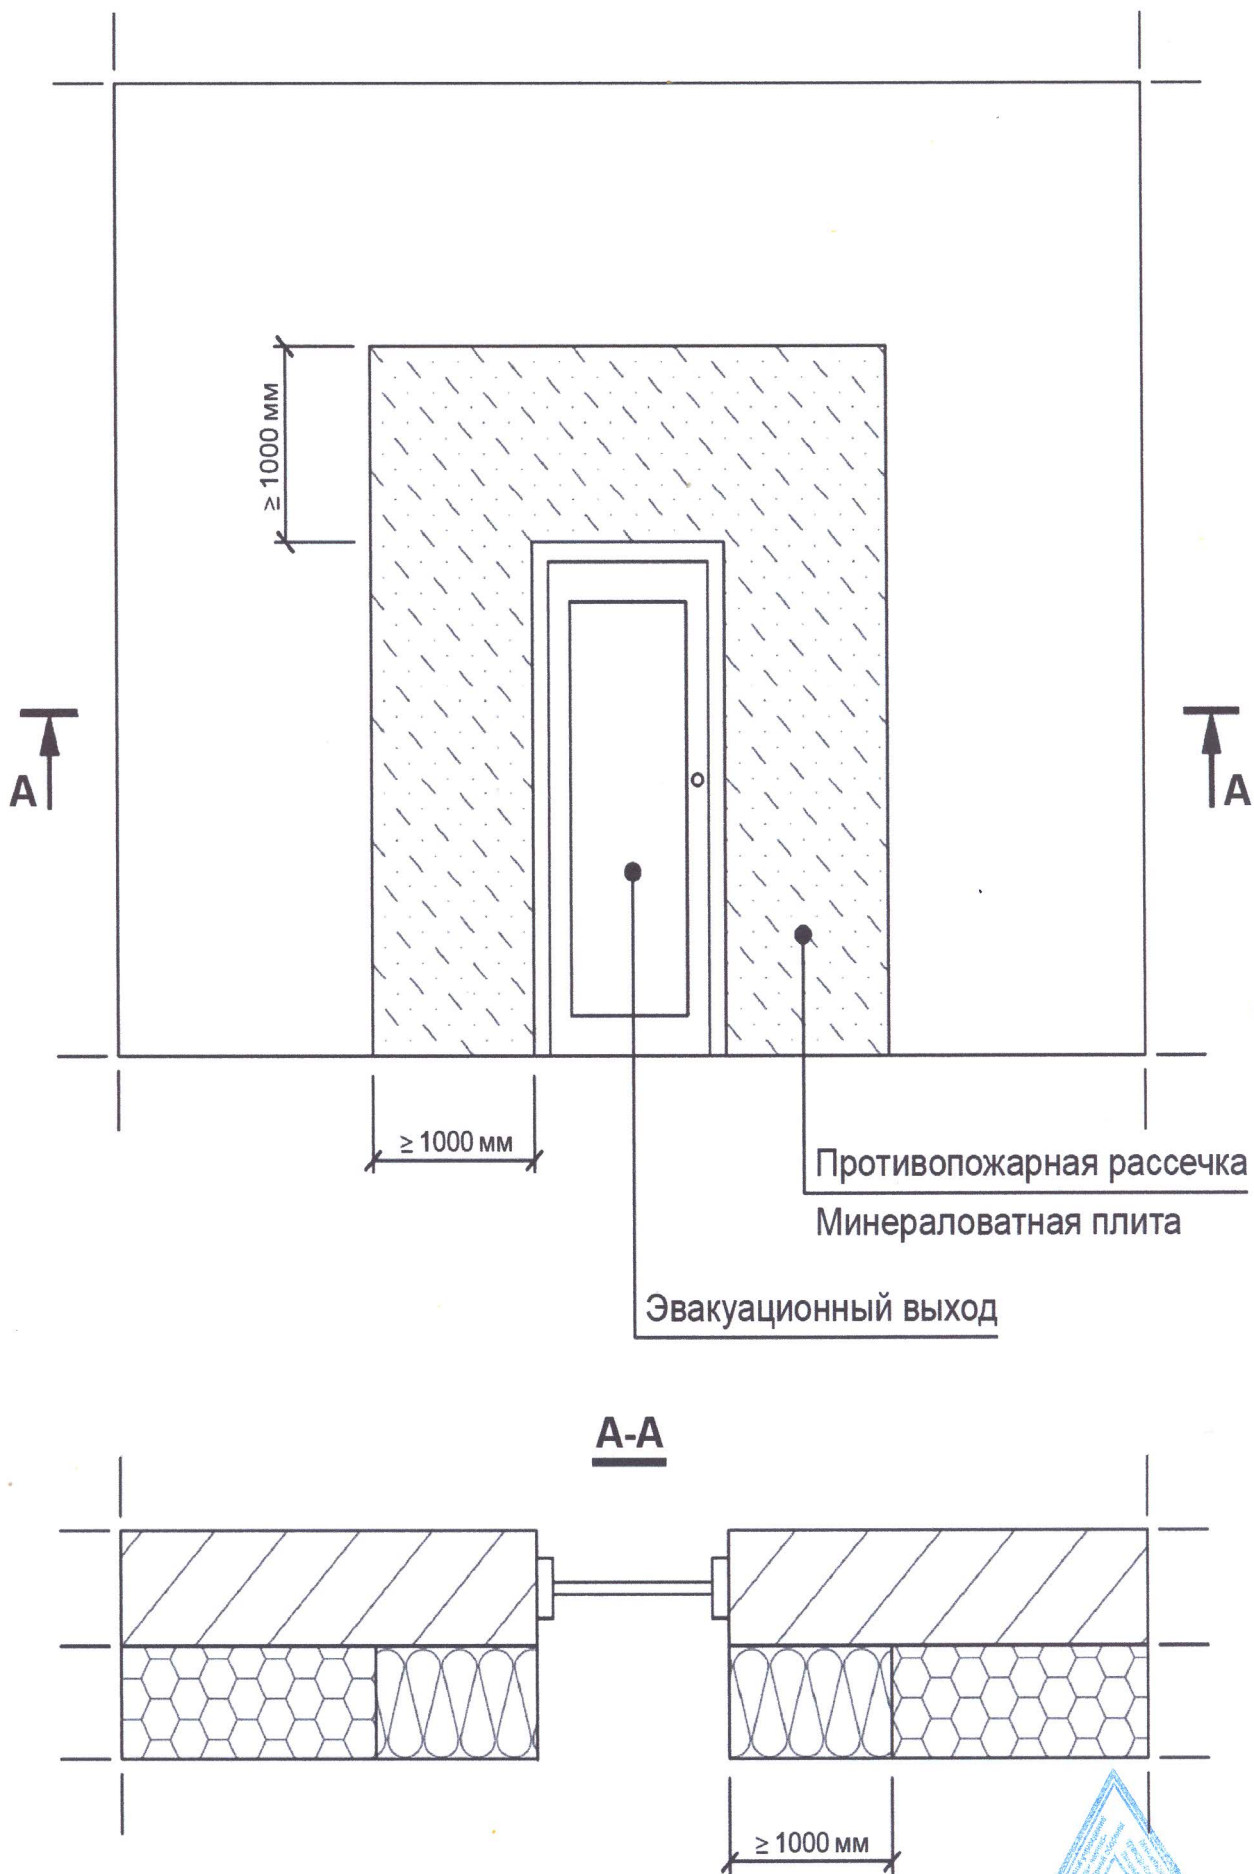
Участки наружных стен по периметру эвакуационных выходов из здания
